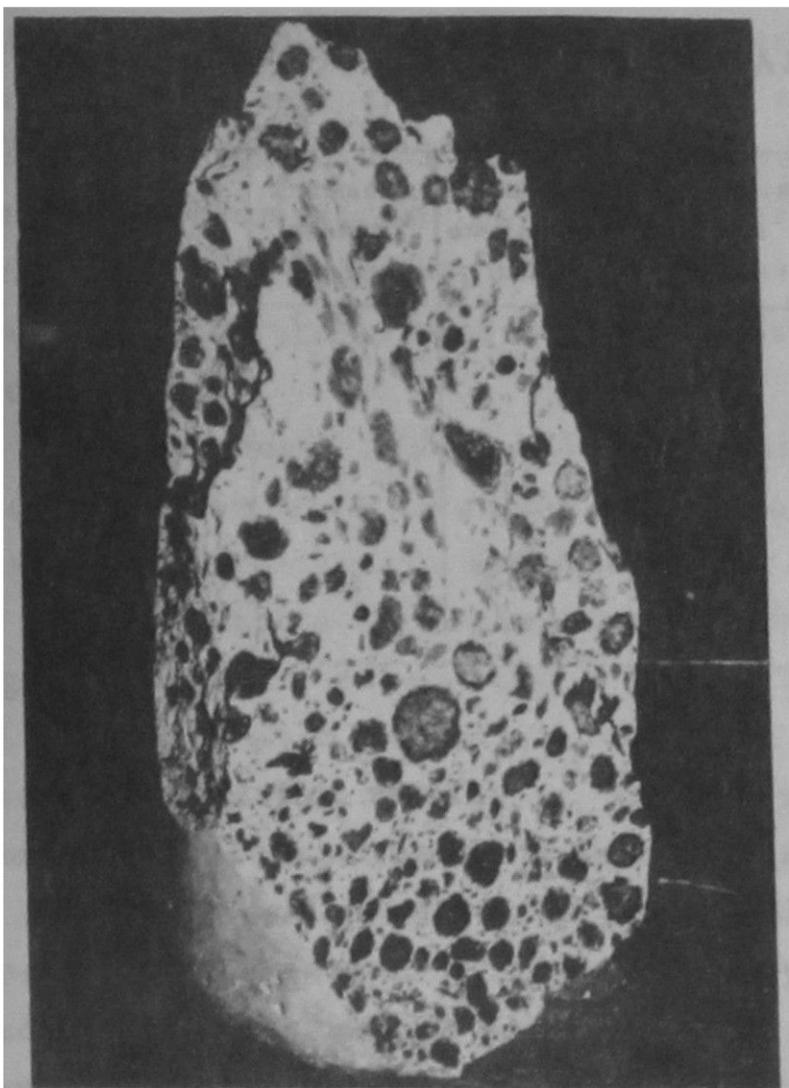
Zona de rotura de una probeta cilíndrica sometida a compresión.
